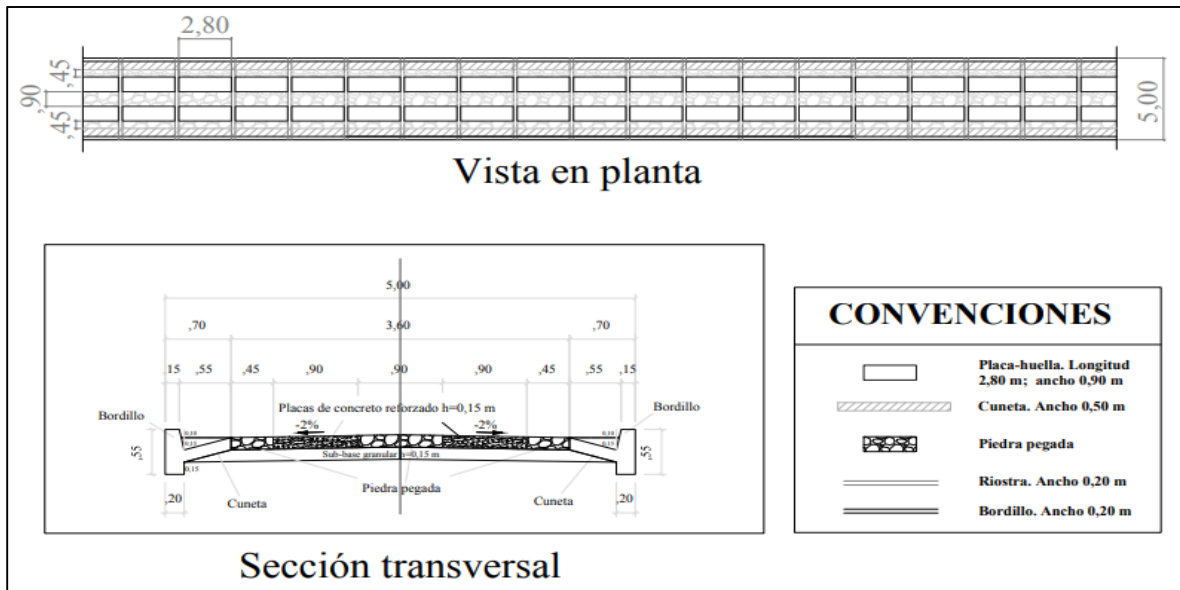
Diseño estructural con corte trasversal y vista en planta para el decimotercer tramo.
